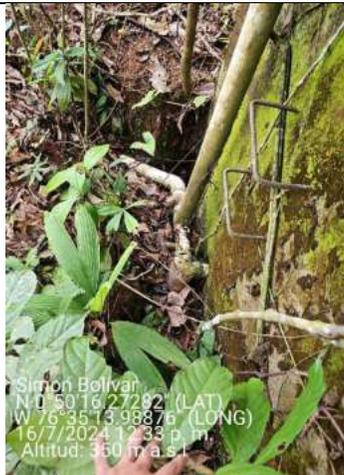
Tubería de entrada Tanque Simón Bolívar.
